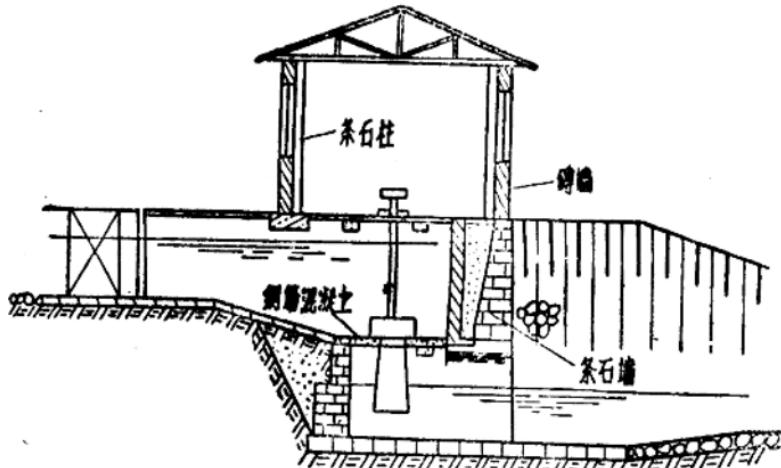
用钢筋混凝土及条石柱、条石砌牆的厂房
